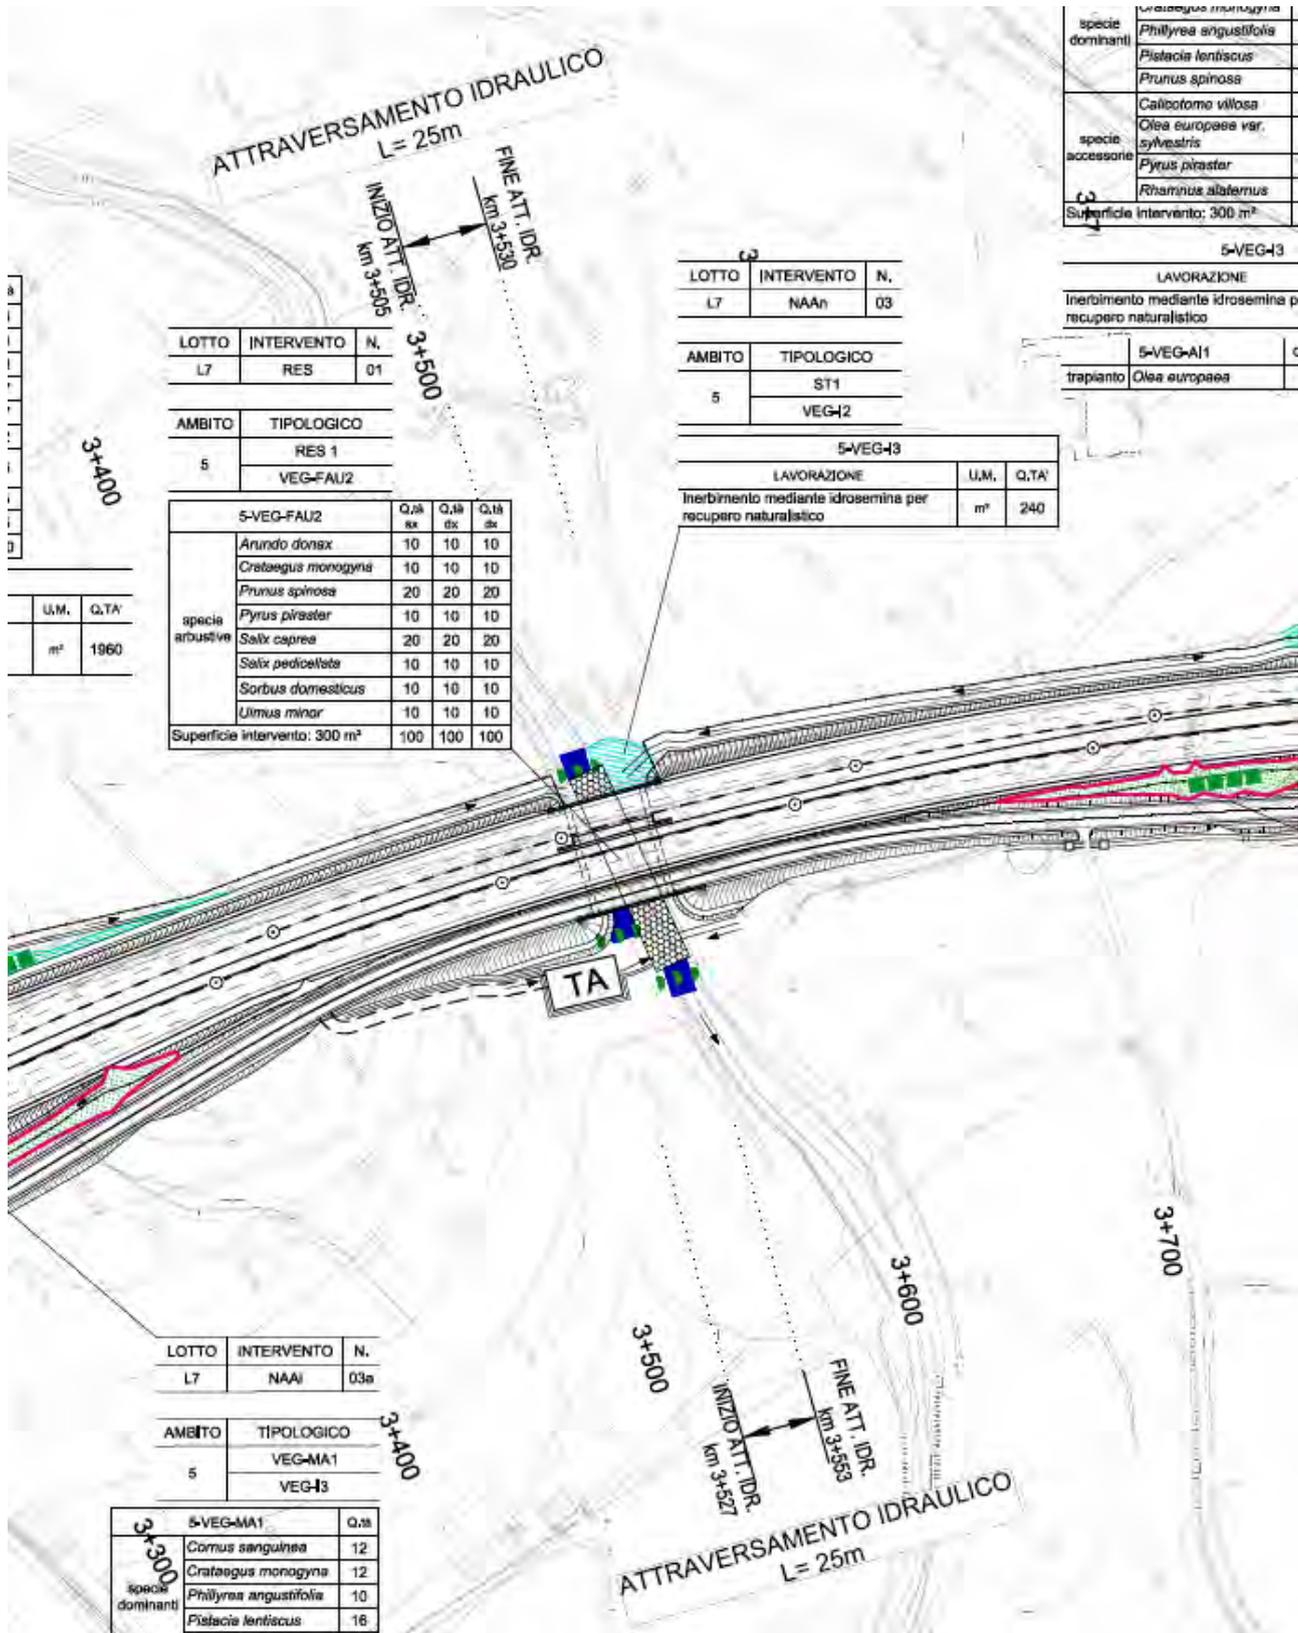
Lotto 7 Stralcio interventi di mitigazione Attraversamento Torrente Canale
